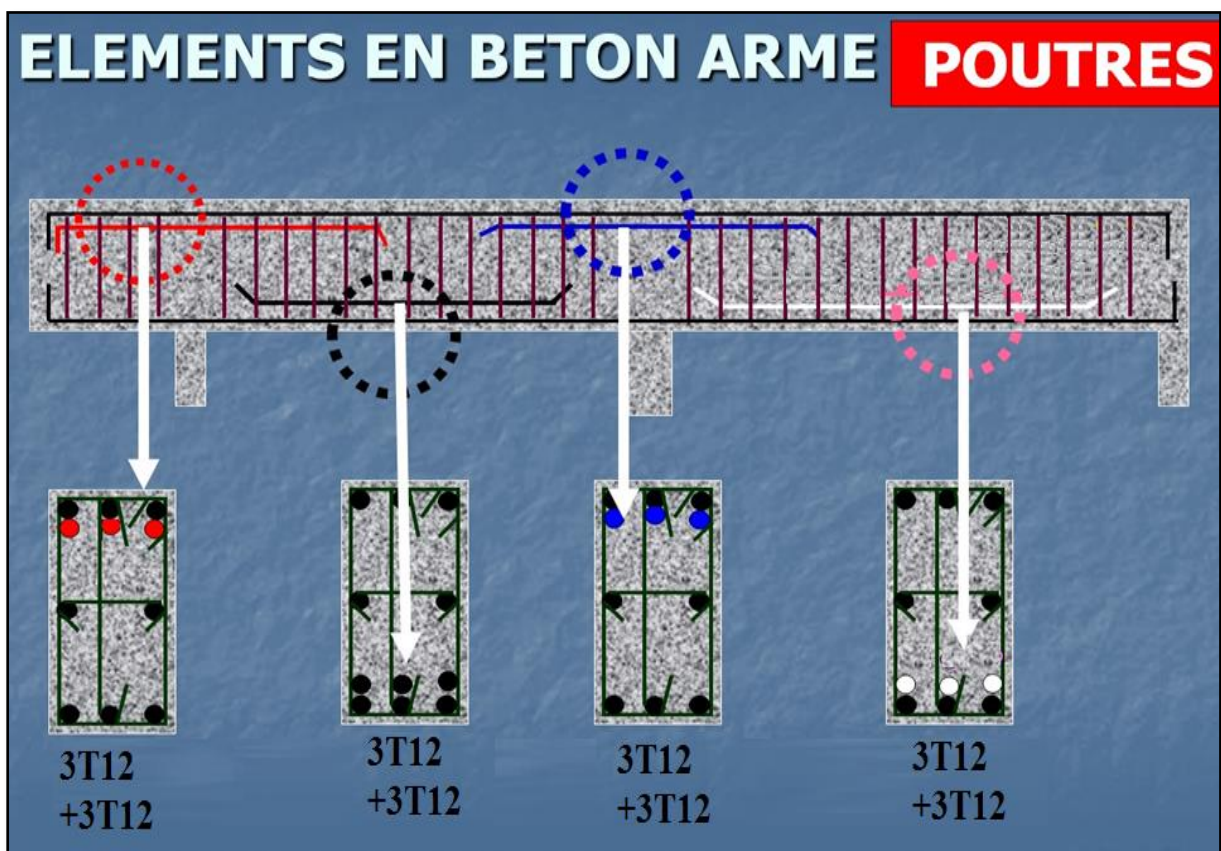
Ferrailage des poutres secondaires du bloc A1 de siège APC.
